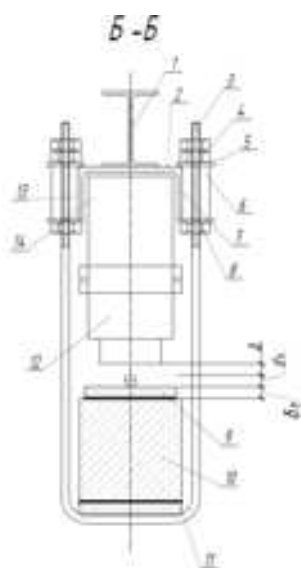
Схема экспериментальной установки для испытания на изгиб железобетонного балочного элемента. Вид сбоку (условные обозначения приведены на рис.1)
